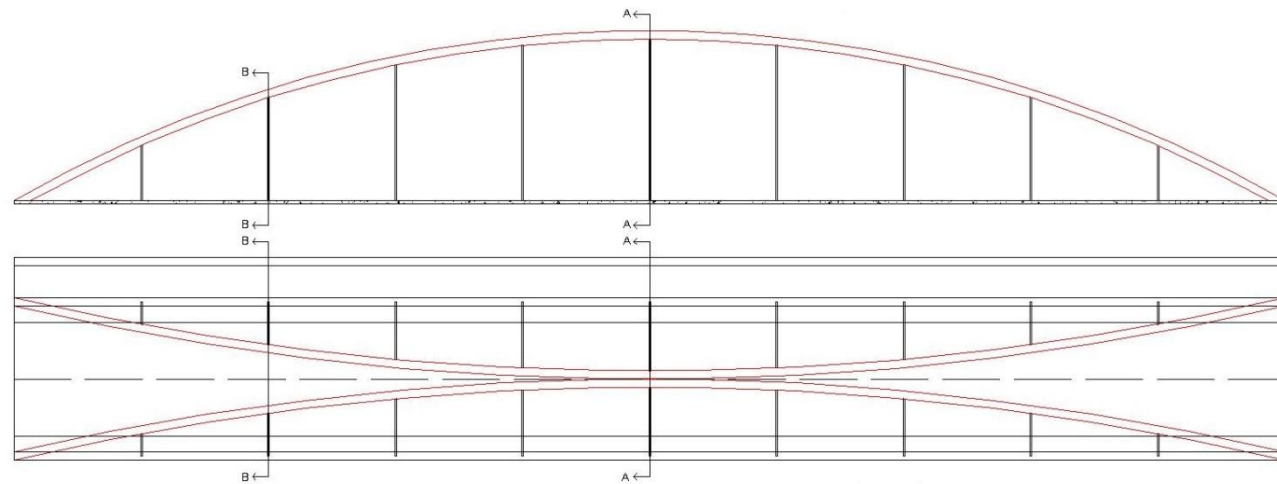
Planta y alzado del puente doble arco atirantado de tablero inferior
